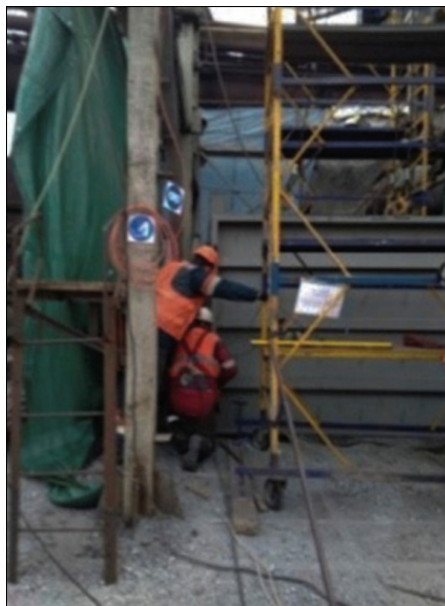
Укрупнительная сборка монтажного блока стенок корпуса фильтра.
